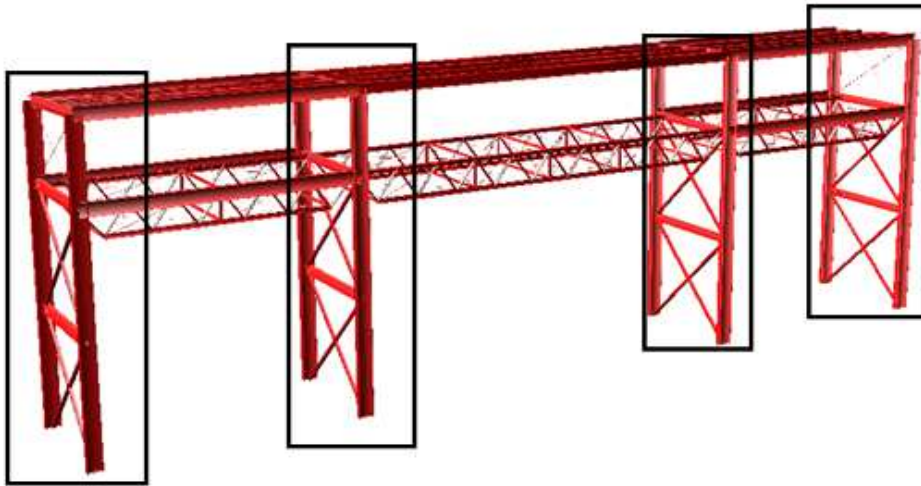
Sistema de contraventamento adotados para redução das acelerações transversais.
